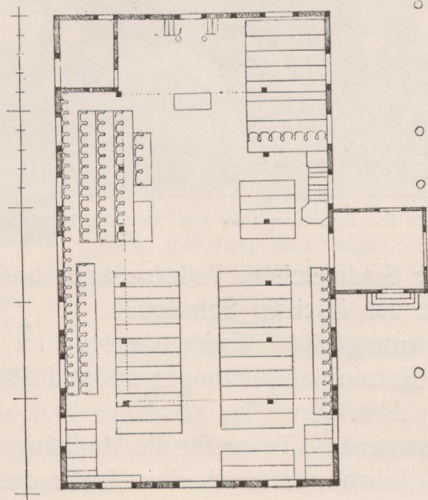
Grundriß der evang Kirche zu Lichtfelde
